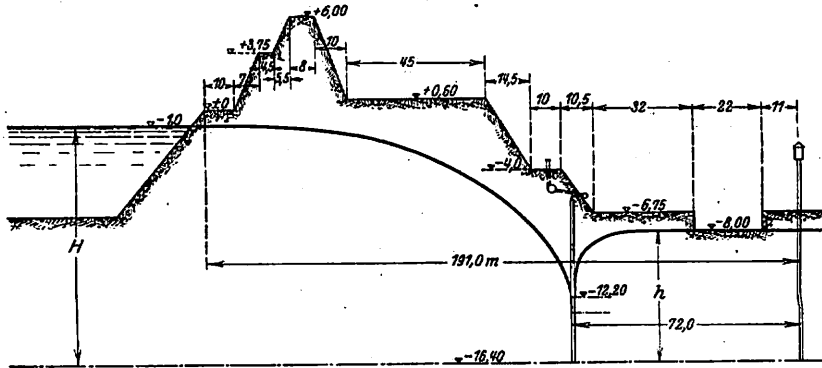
Senkungsanlage für Schleuse Wemeldinge; Schnitt C—D.
